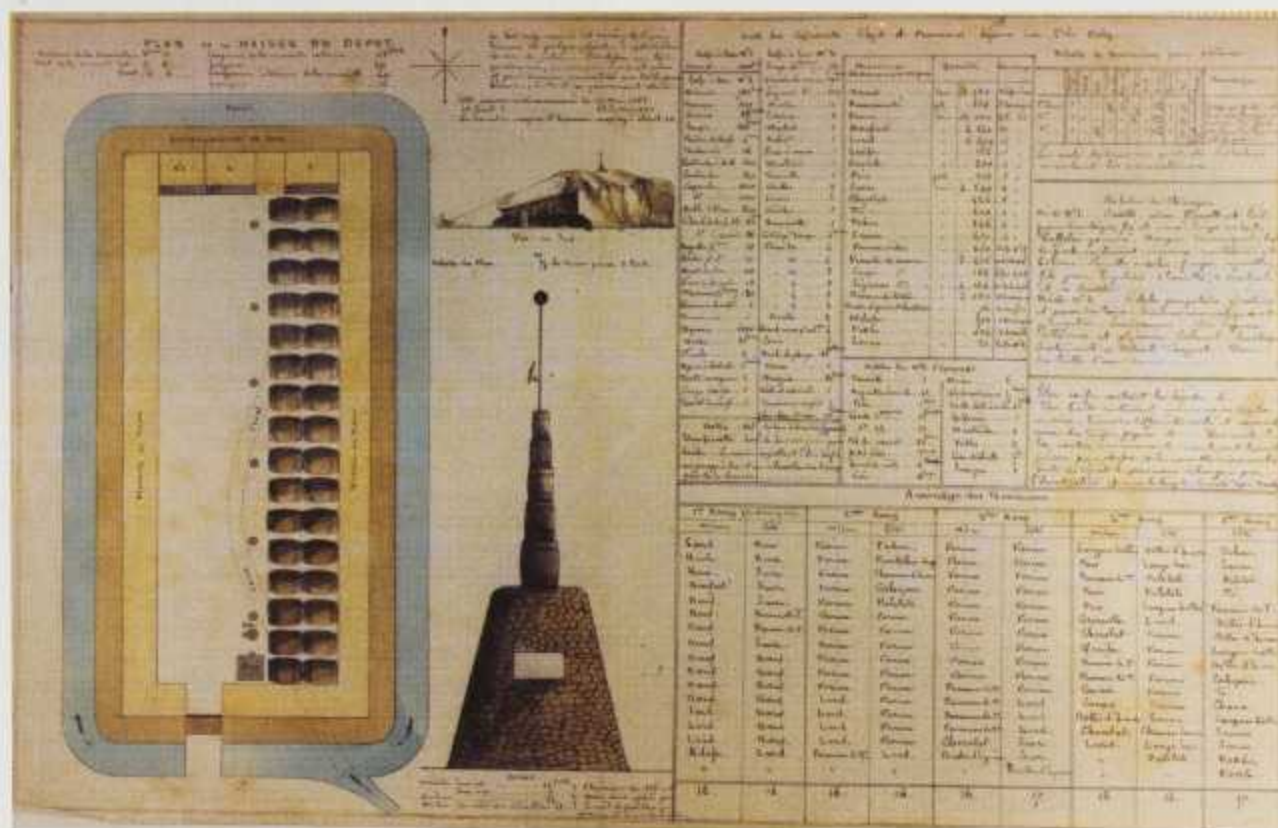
Plan du dépôt de vivres construit sur l'île Dealy du 17 mai au 25 juillet 1853 (plan dressé par E.F. DE BRAY).
